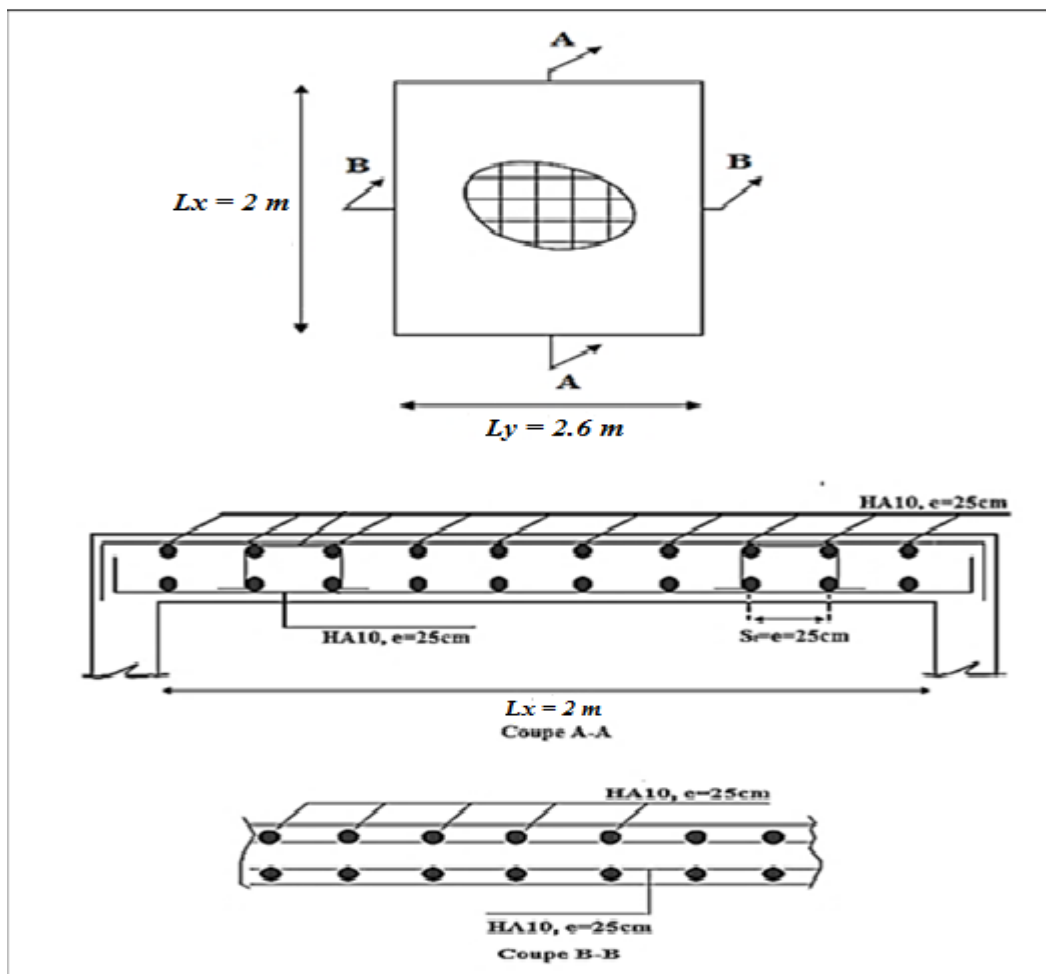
Schéma de Ferrailage de la dalle machine.
